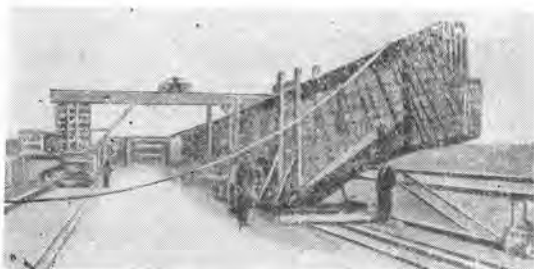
鉄筋コンクリート橋梁の主梁鉄筋の組立
